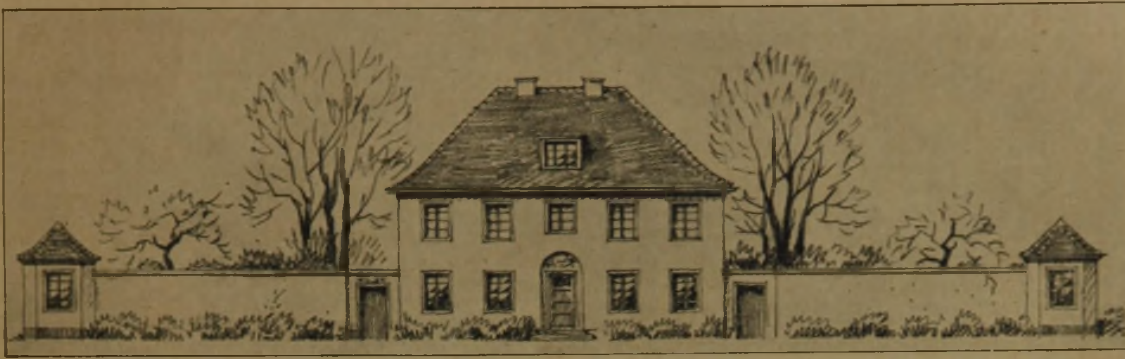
Typ eines zweigeschossigen Doppelhauses. (Grundrisse Abb. 11.)
